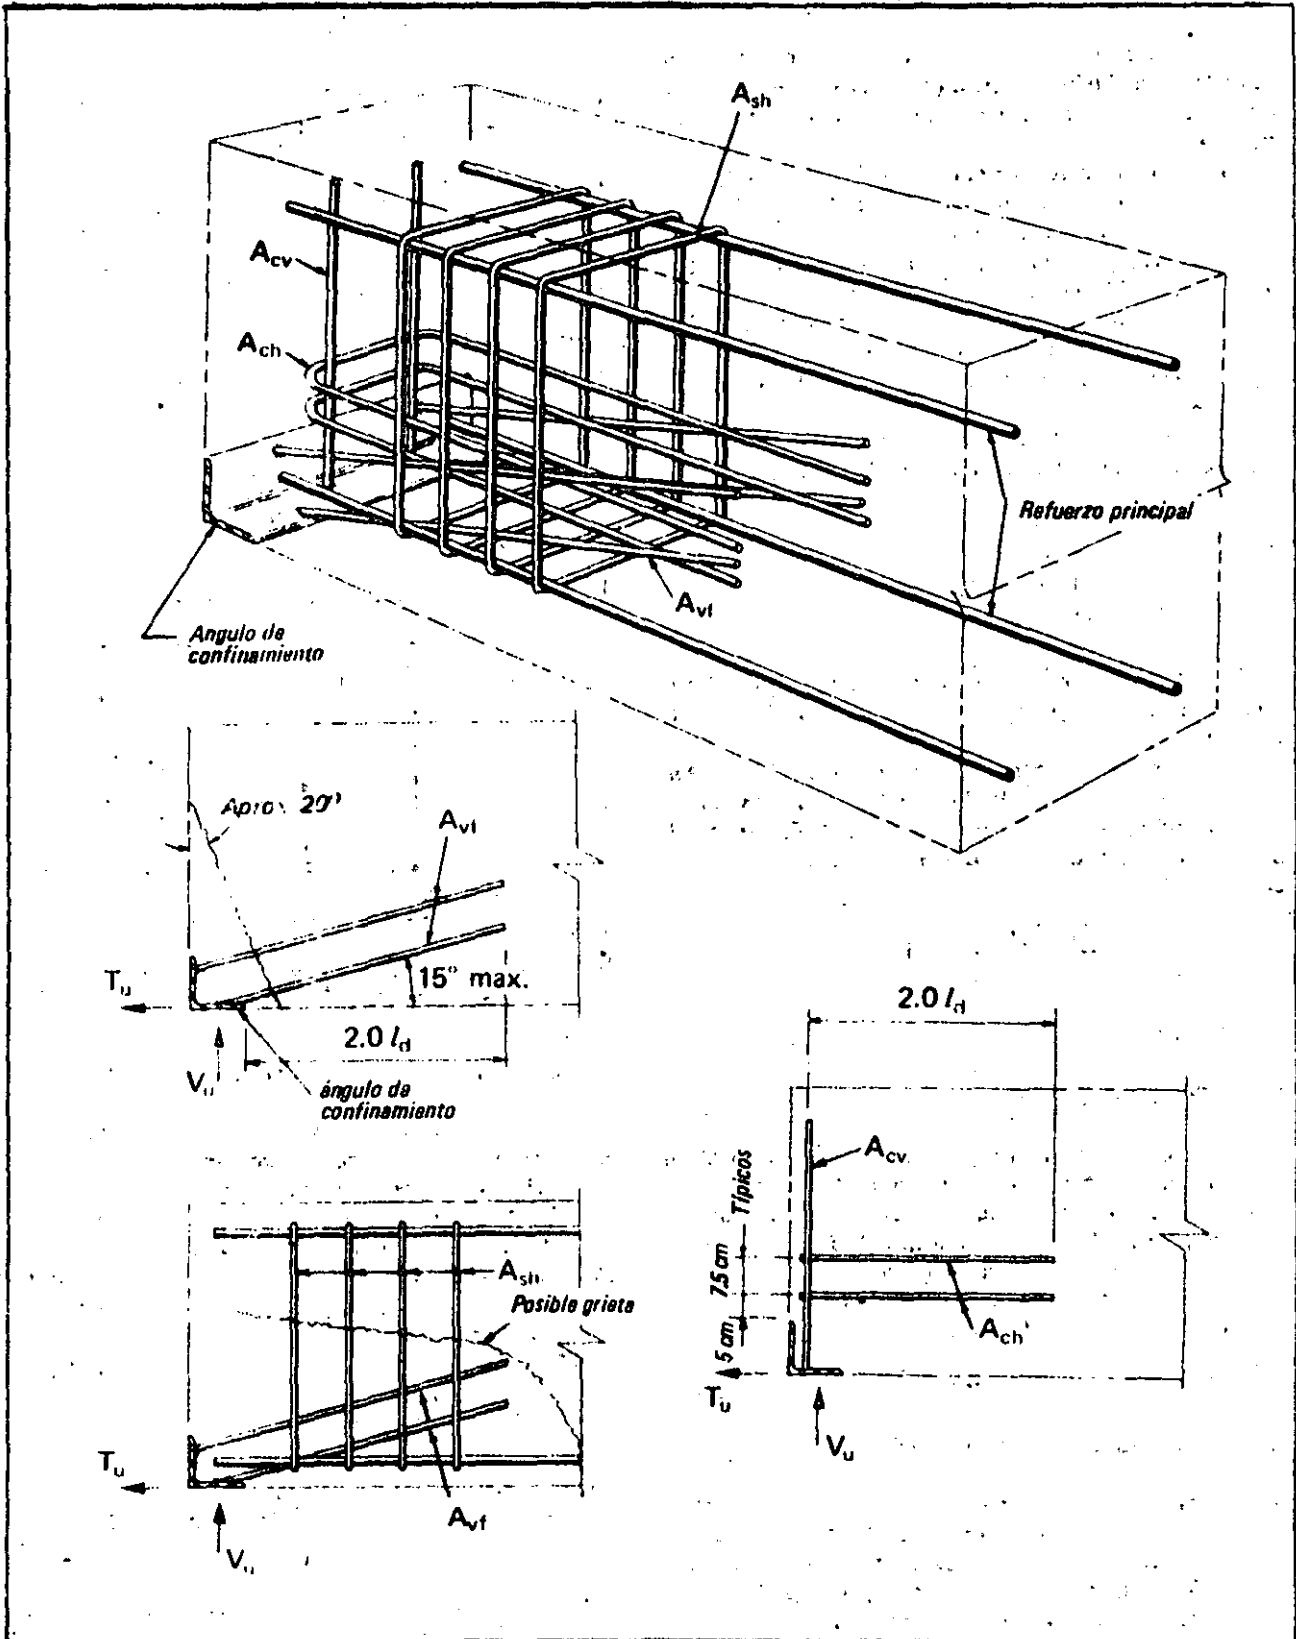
Condiciones del apoyo en concreto confinado
